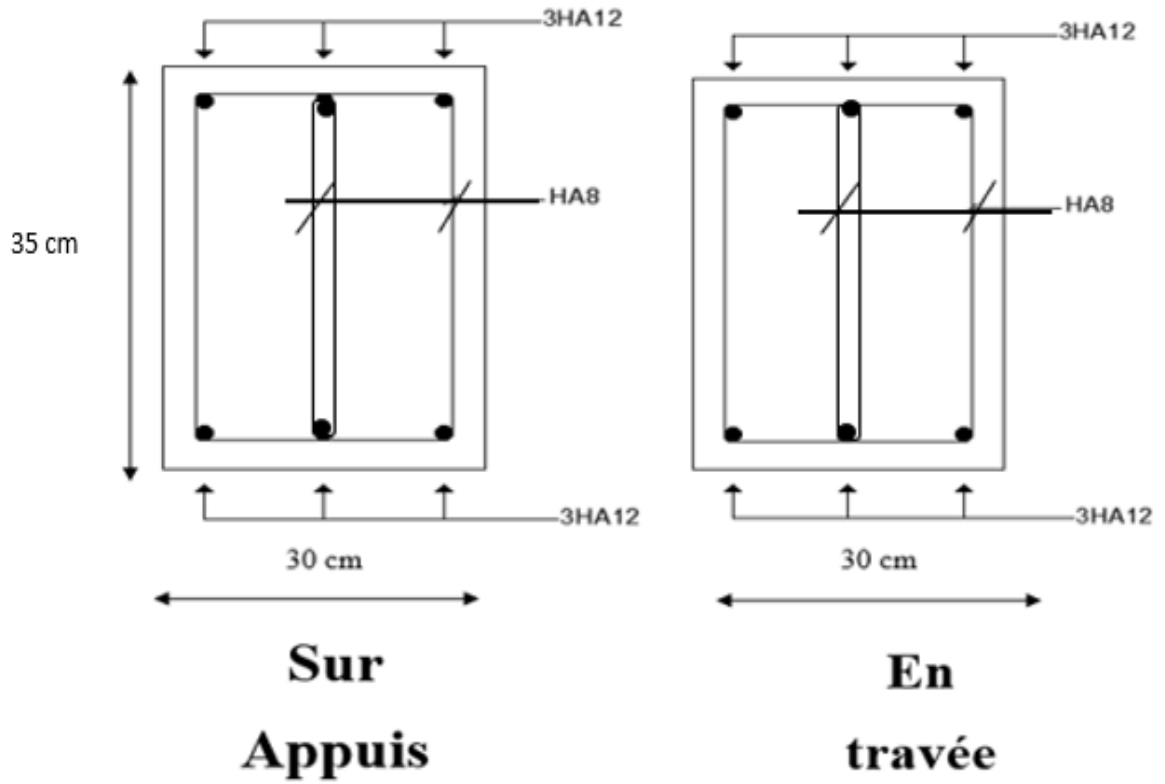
Coupe de ferrailage des poutres secondaires au niveau d'appuis et travée (terrasse)
